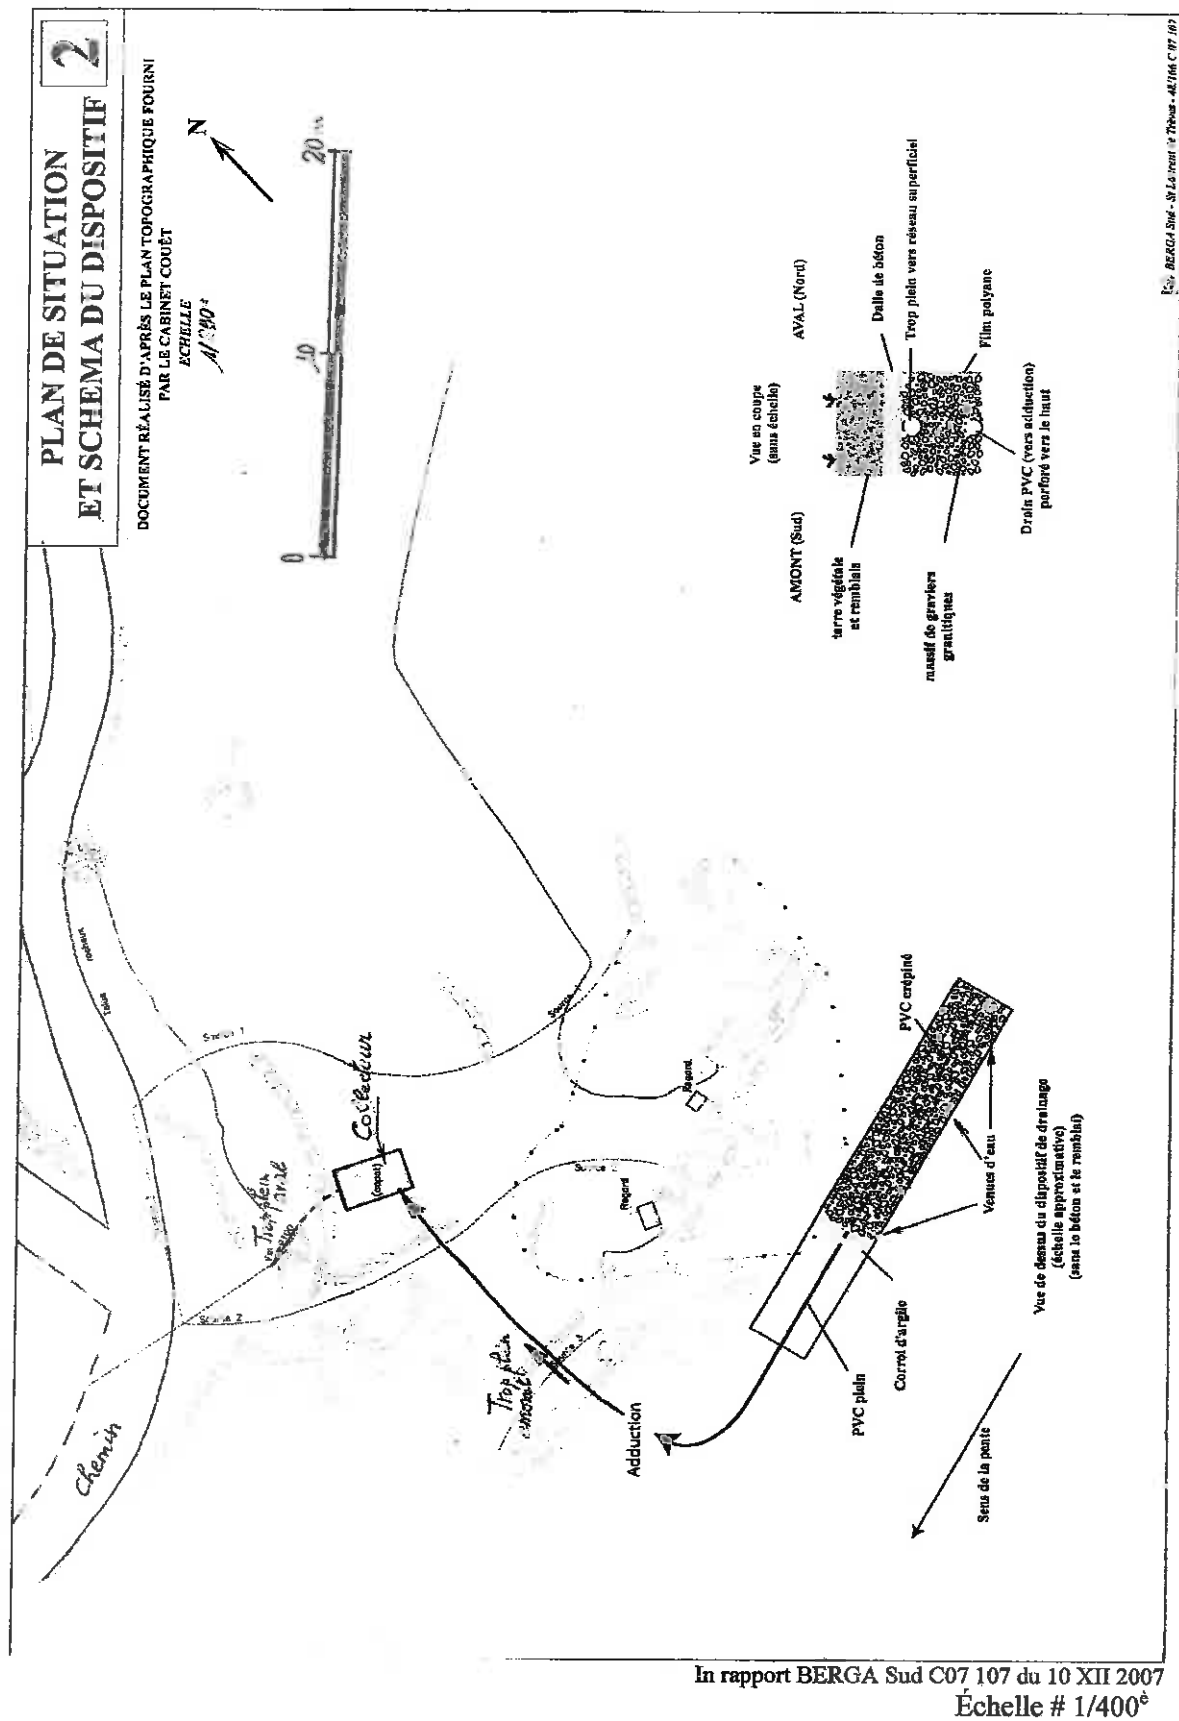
Plan de situation et schéma du dispositif drainant de la Source de FAJAS
